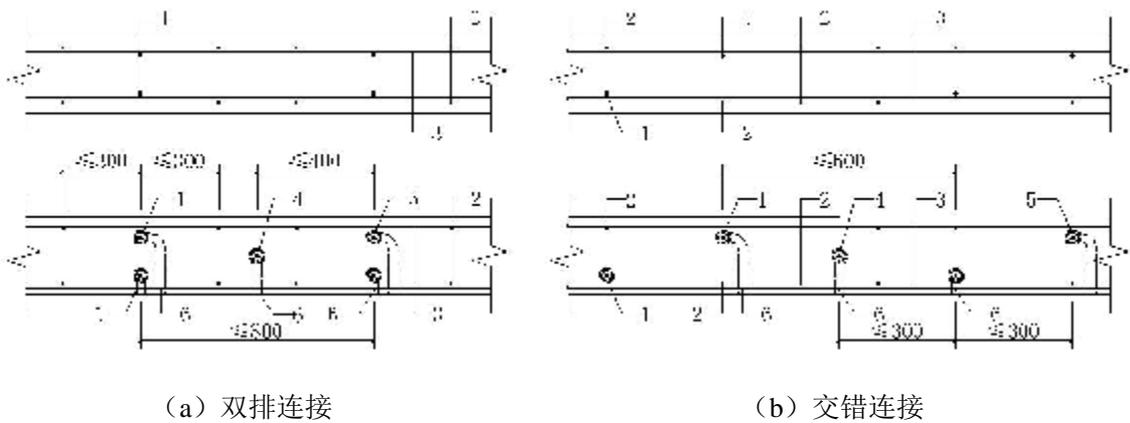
预制墙板双排钢筋连接的竖向分布钢筋构造示意
